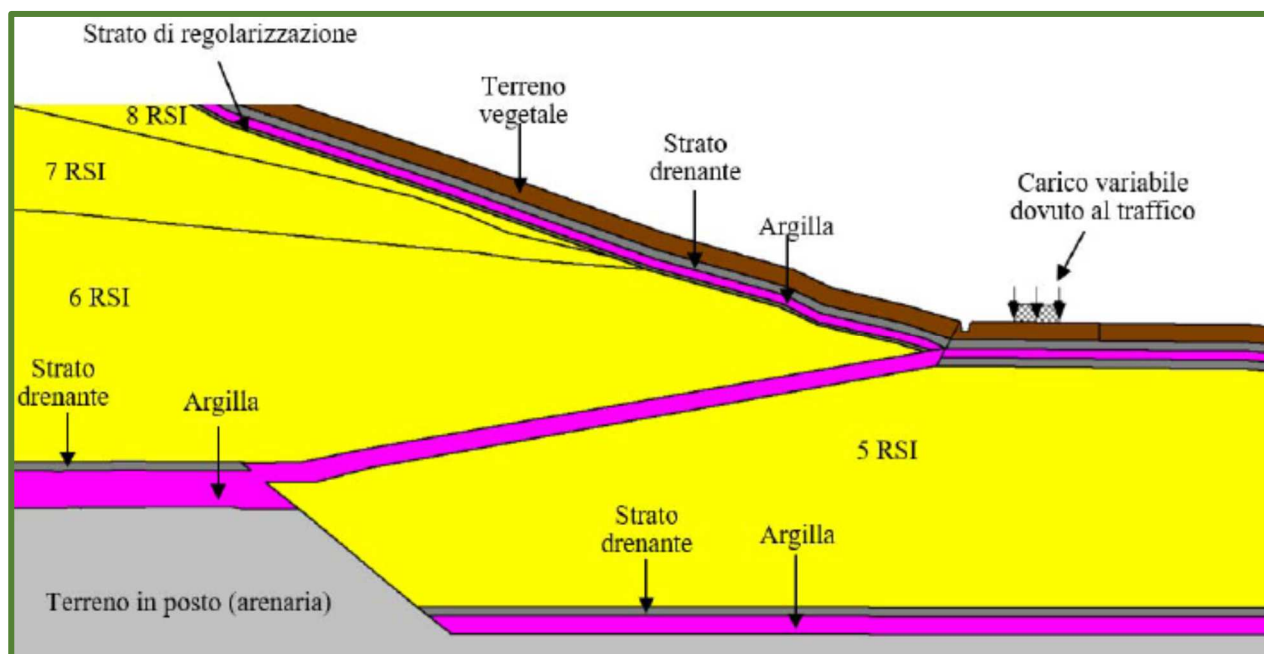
/V – Sezione A-A' – Sponda sud-ovest - Particolare 1
